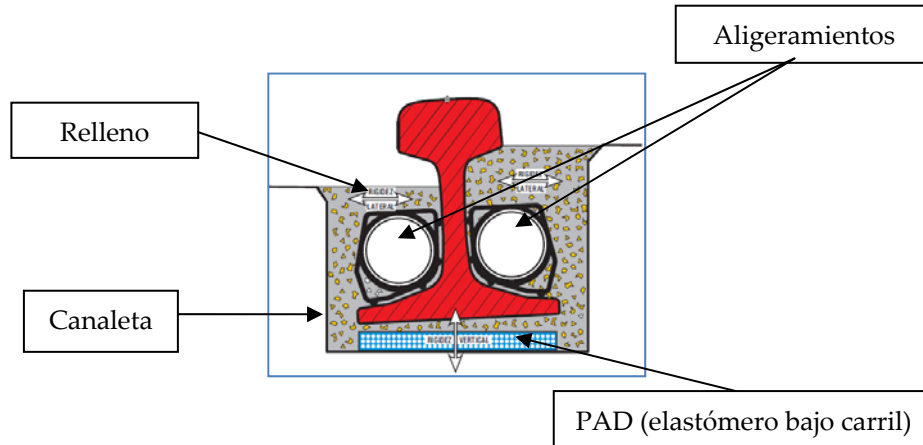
Elementos constituyentes de la superestructura tranviaria. Detalle sistema de fijación del carril embebido. Fuente: Elaboración propia a partir de [4]
